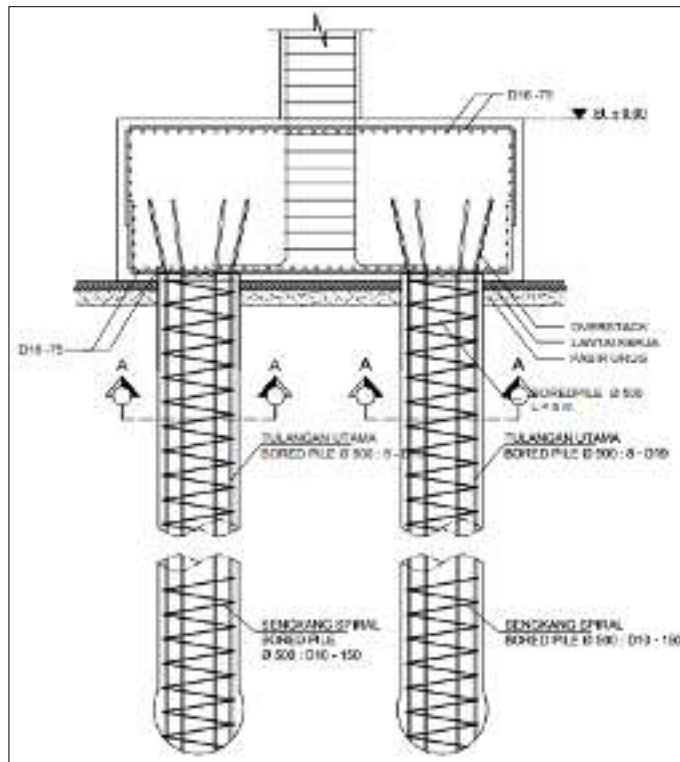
Fondasi Tiang Pancang Beton
